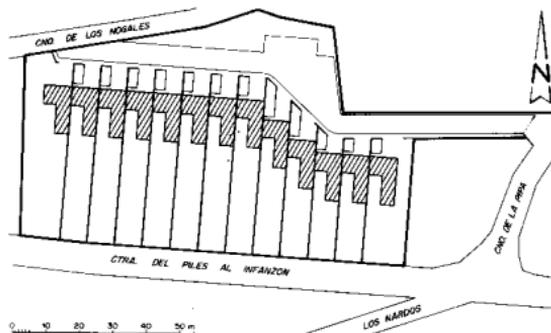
Planta de "Los Nogales" (La Pipa), urbanización pionera de adosados emplazada sobre el eje de la carretera del Piles al Infanzón. 1984.
